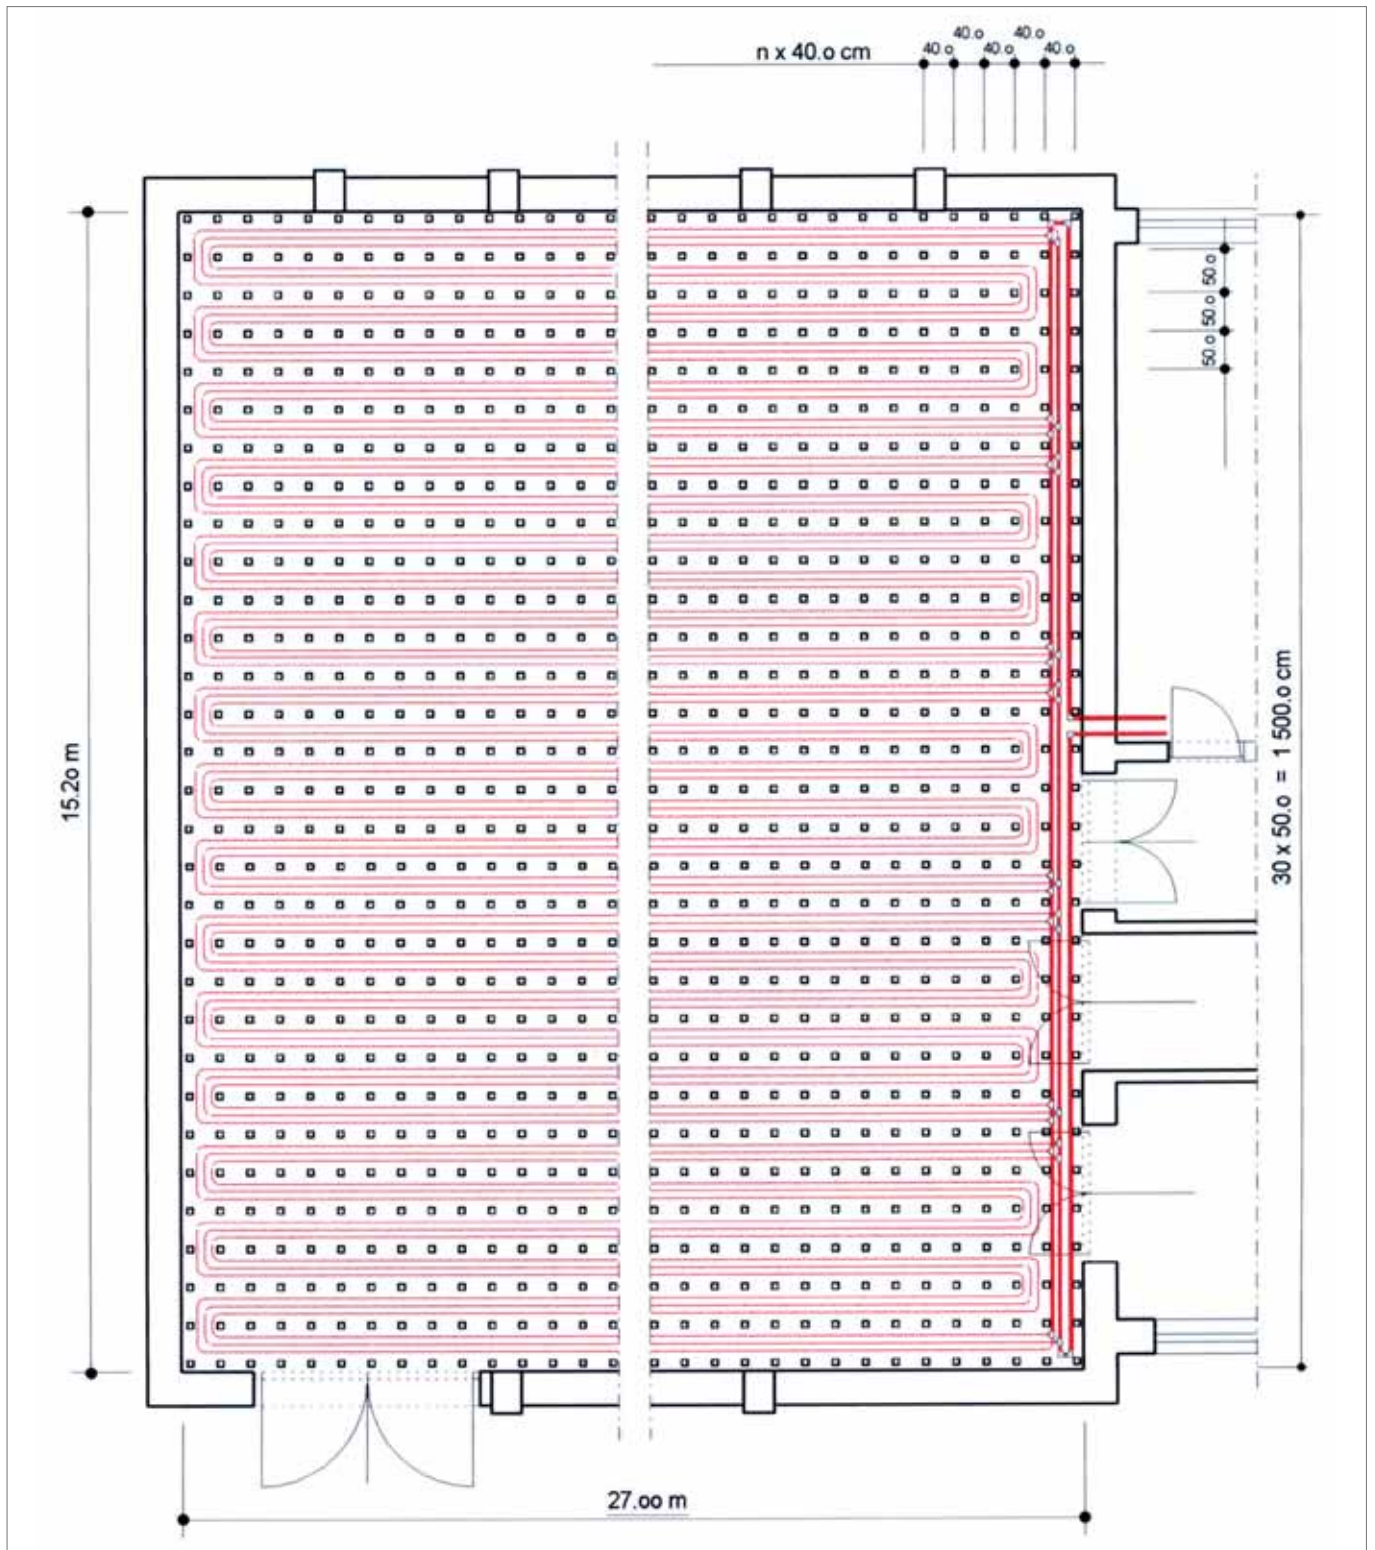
Representación esquemática para el calefacción de pavimentos elásticos con un colector con retorno invertido
